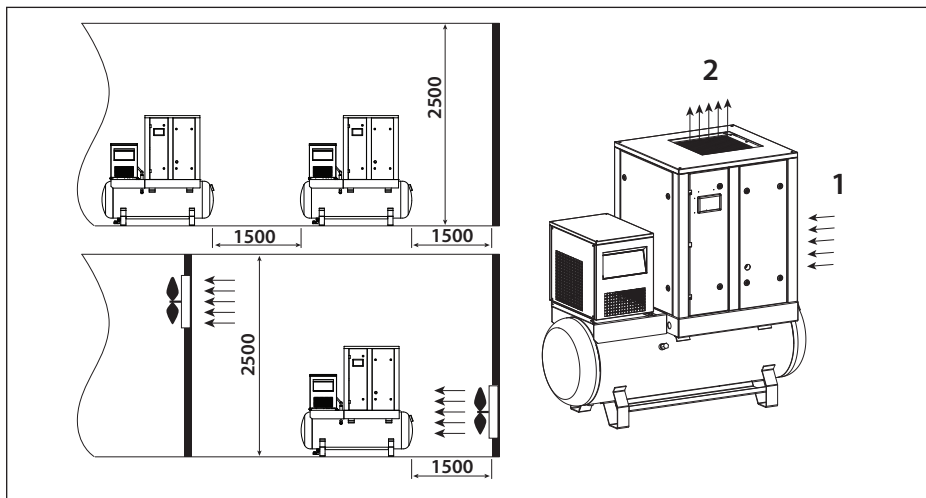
Схема установки компрессора AR/FR.. ,ARD/FRD..
